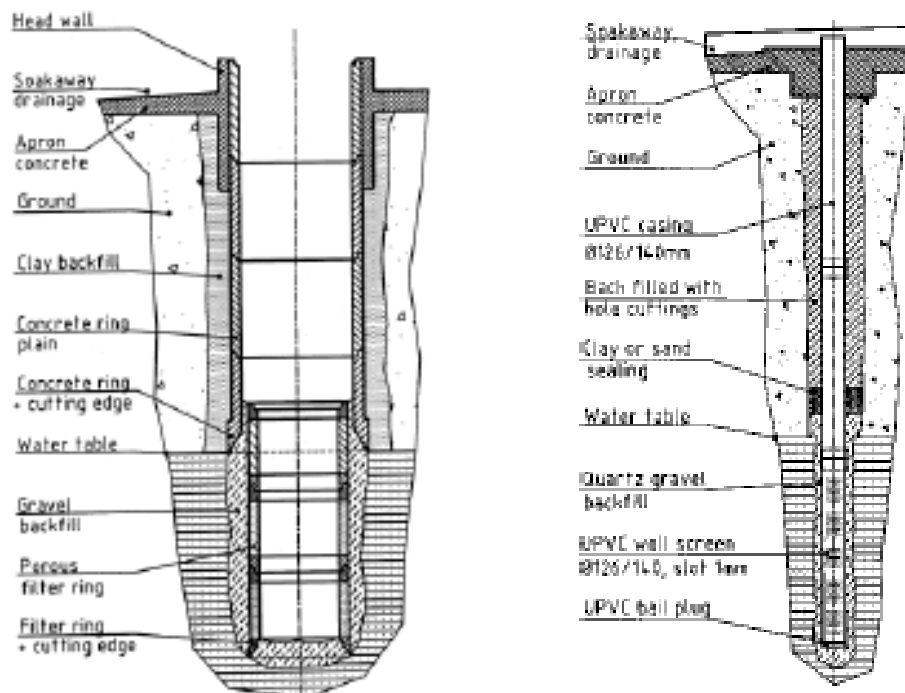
Pozo excavado / Pozo perforado (Baumann, 2000)
